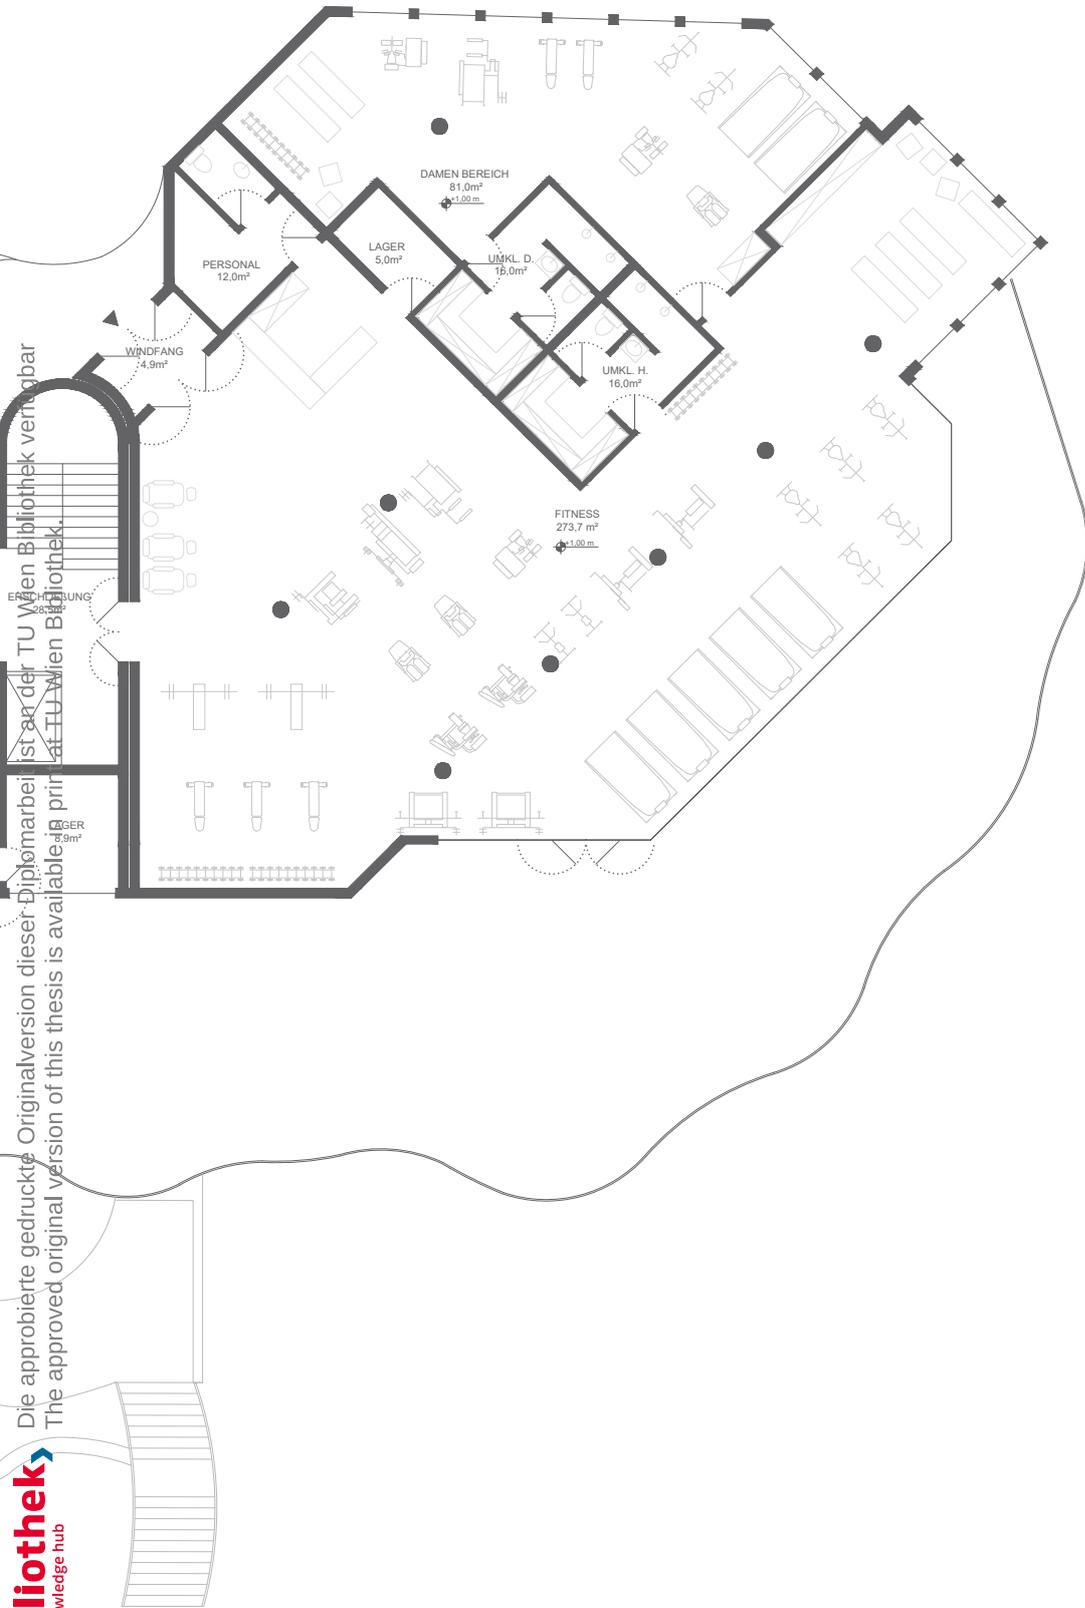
Grundriss Erdgeschoss
